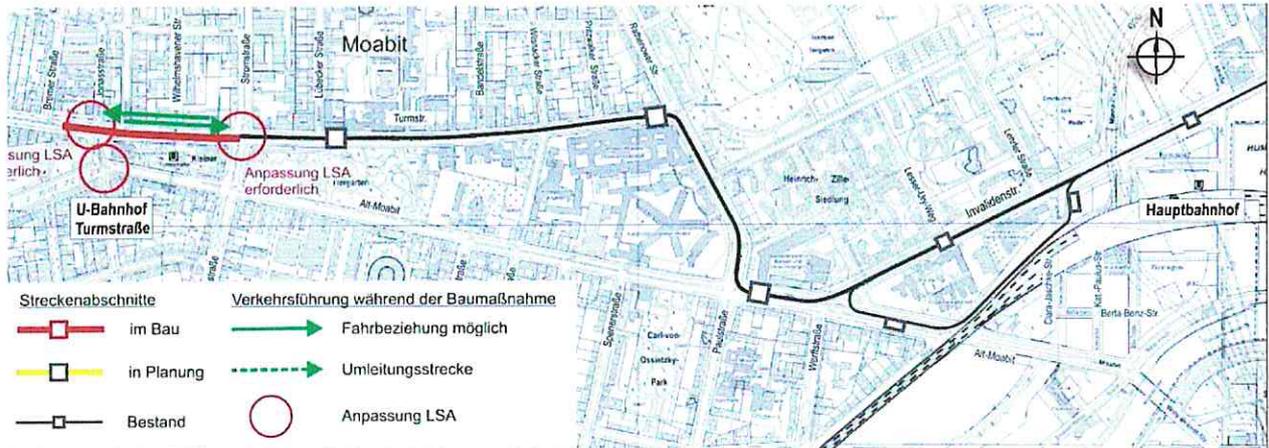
Verkehrsführung Bauabschnitt 5.1 – Turmstraße West
